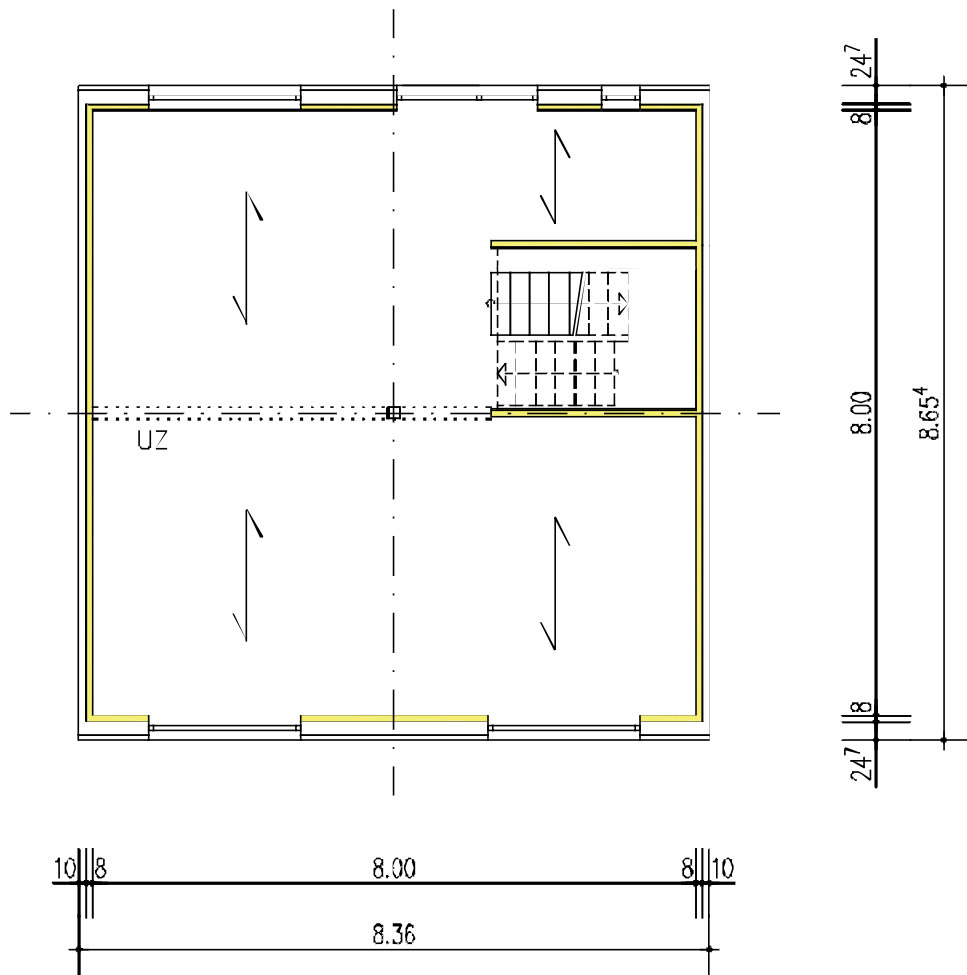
Grundriss Tragsystem, M 1:100
